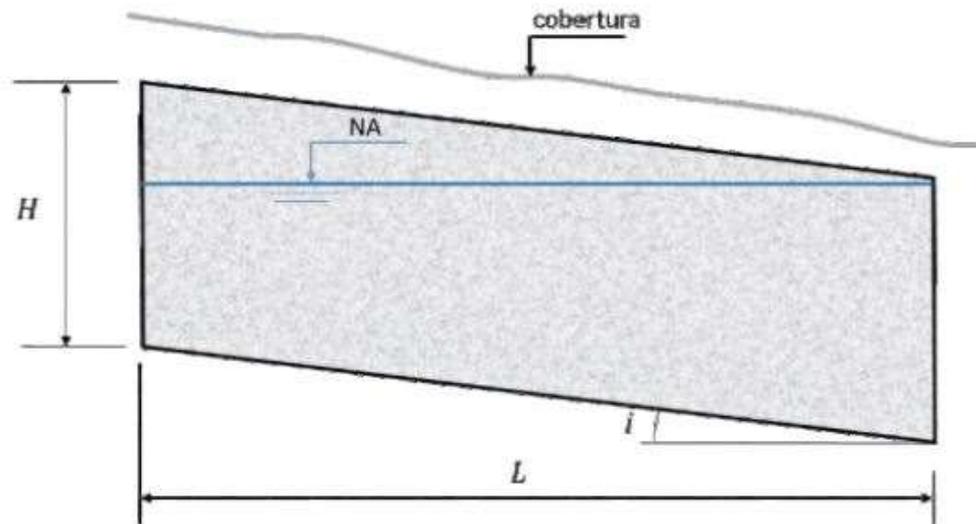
Trincheira de Infiltração - corte longitudinal típico
